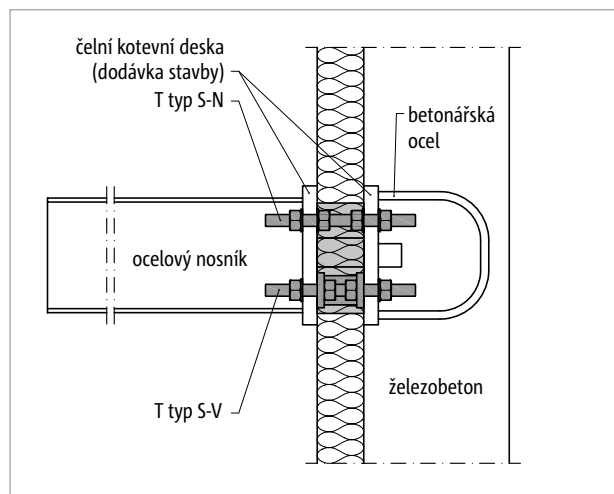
Schöck Isokorb® T typ S: Vnější roh (nárožní markýza)
